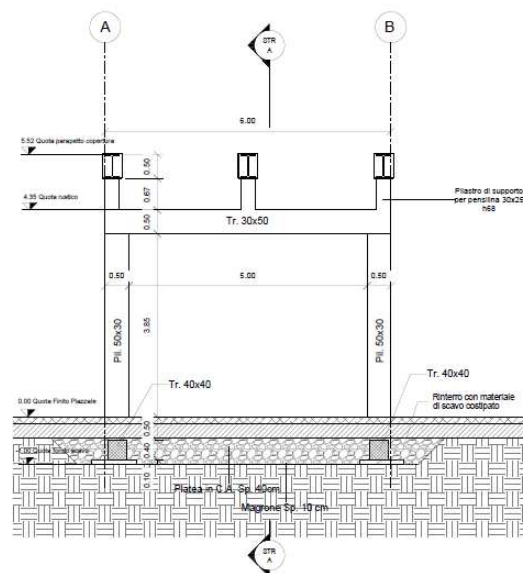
Carpenteria Fondazione, Copertura e Parapetto.
